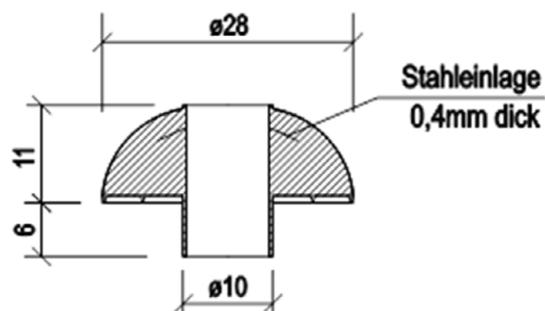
Pilzkopfdichtung aus Kunststoff mit Stahleinlage für die Sechskant-Holzschraube nach Bild 2.1 und für Stahlhaken nach Anlage 4, Bild 4.1
